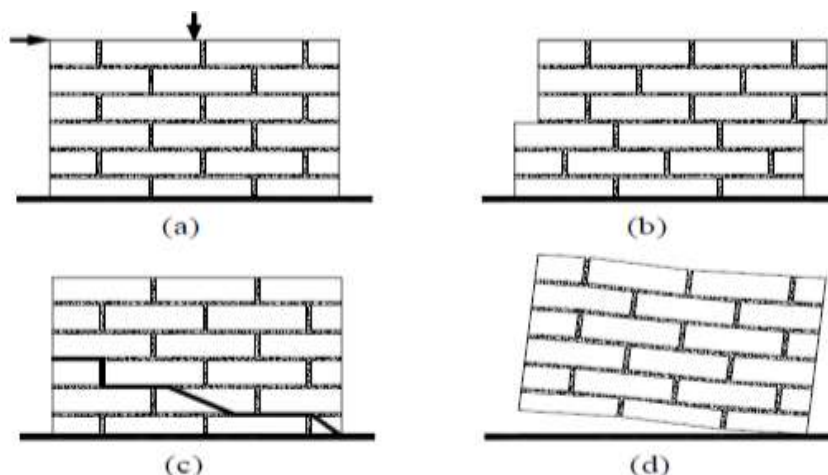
Mecanismos de rotura em paredes de alvenaria quando solicitadas no seu plano por cargas horizontais e verticais (Roque 2002): (a) parede sob carregamento vertical e lateral; (b) rotura por corte da argamassa nas juntas; (c) a parede funciona monoliticamente exibindo deformabilidade de corte até que os mecanismos internos de tração, associados ao funcionamento por resistência ao corte da parede, rompem; (d) rotação e esmagamento localizado.
